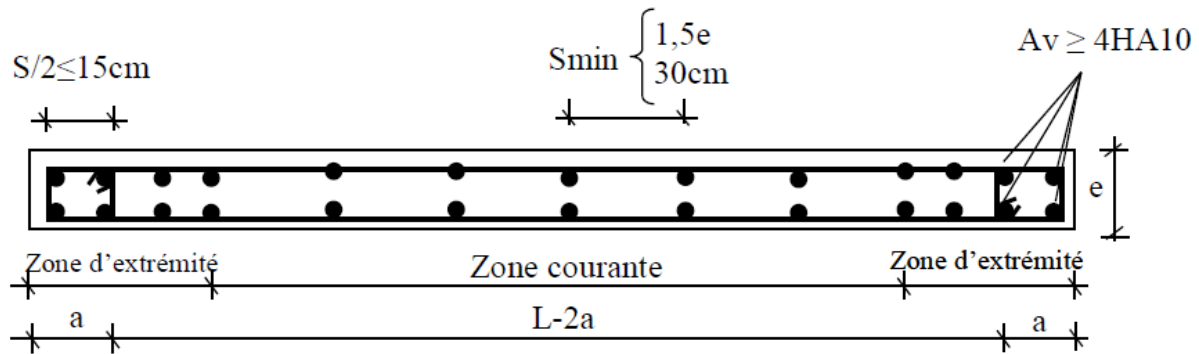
Disposition des armatures verticales et horizontales dans les voiles de contreventement.
